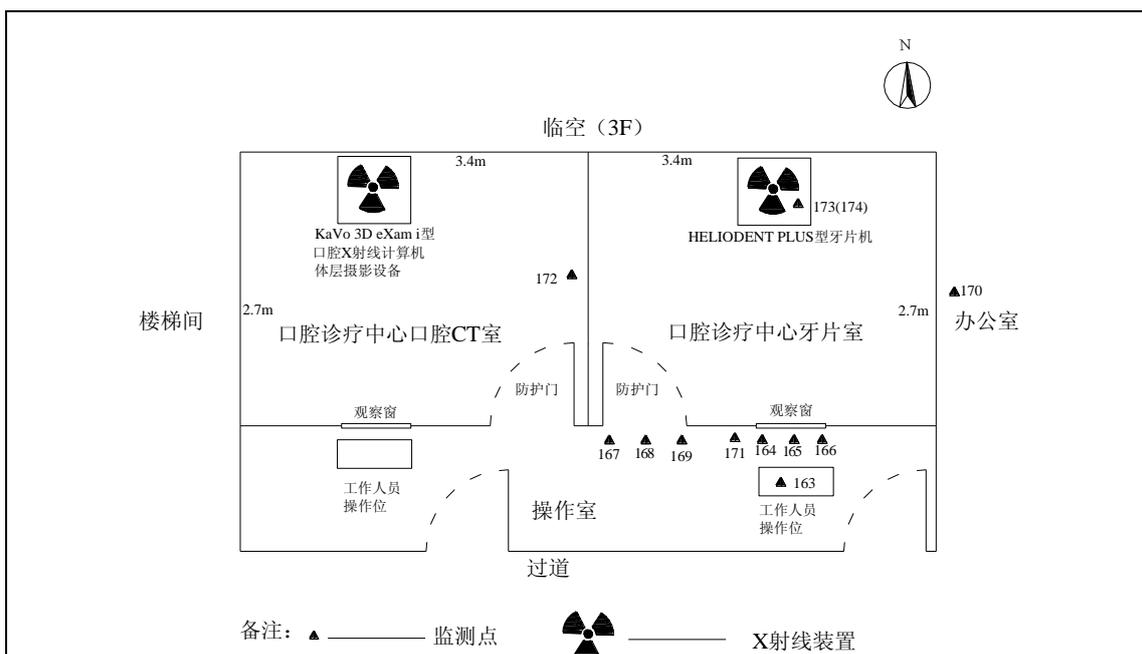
门诊楼 1 区 3 楼口腔诊疗中心牙片室现场监测点平面图
